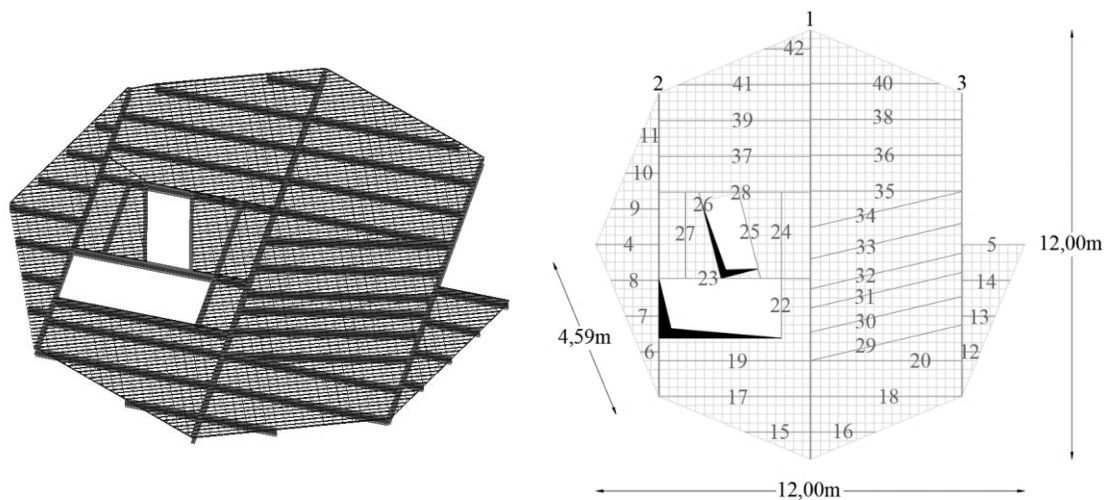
Identificação das vigas principais e secundárias da plataforma metálica.
